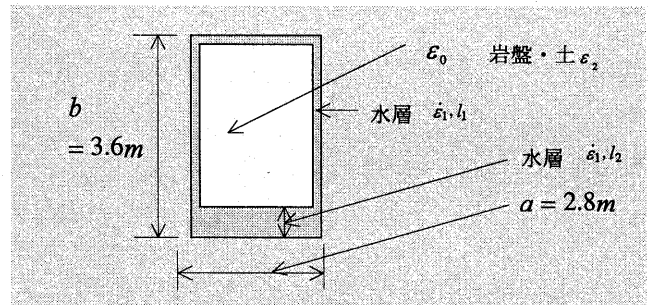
掘削中の岩盤トンネル断面 (Cross-section of tunnel being excavated through bedrock)
